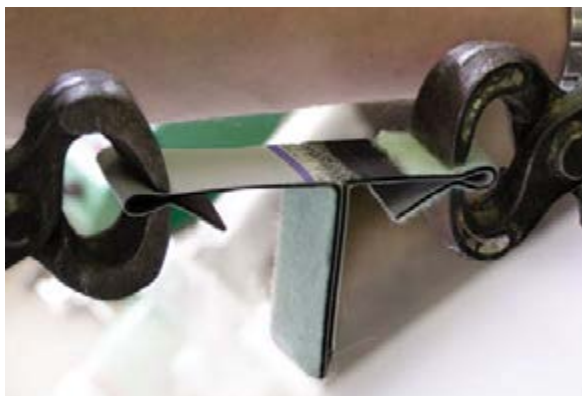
Когезионный разрыв сварного шва неармированной и армированной мембраны
